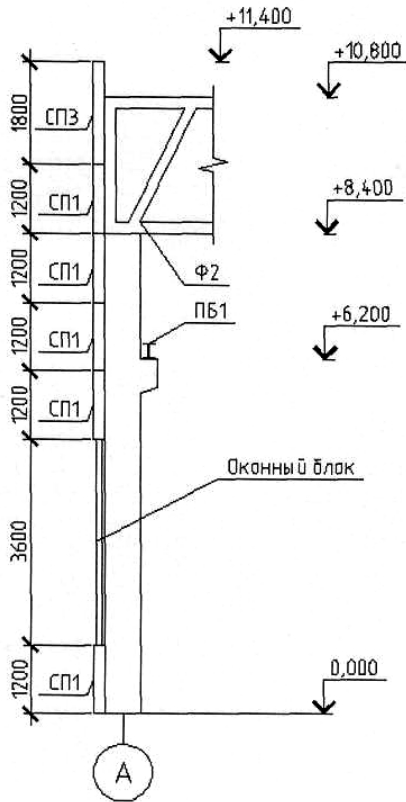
Висотна схема розташування конструкцій каркаса одноповерхової промислової будівлі (приклад)
